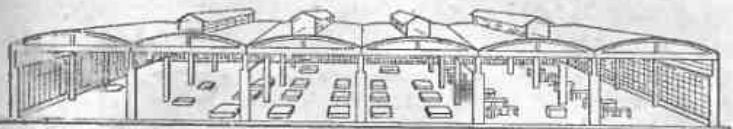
Главный корпус (макет) Кондопожского камнеобрабатывающего завода
